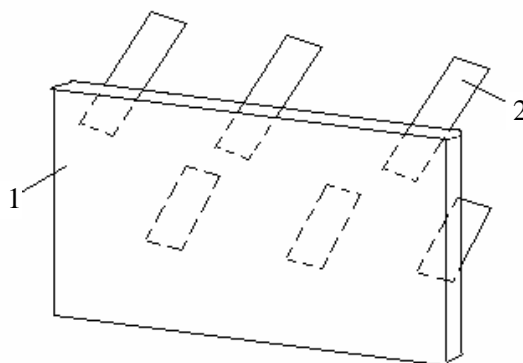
Схема модели подпорной стенки из армированного грунта (1 – наружная оболочка; 2 – армирующие элементы)
